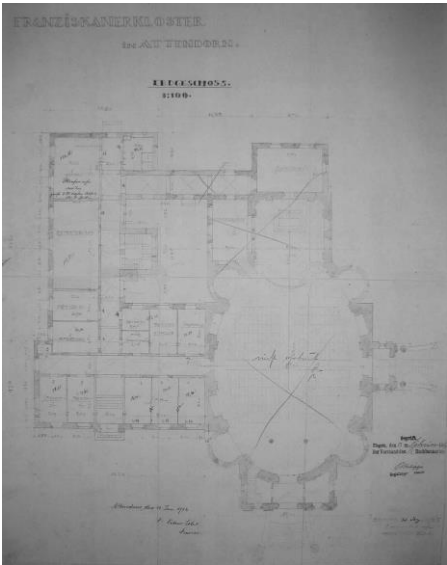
Grundriss Erdeschoss, 31.12.1925
